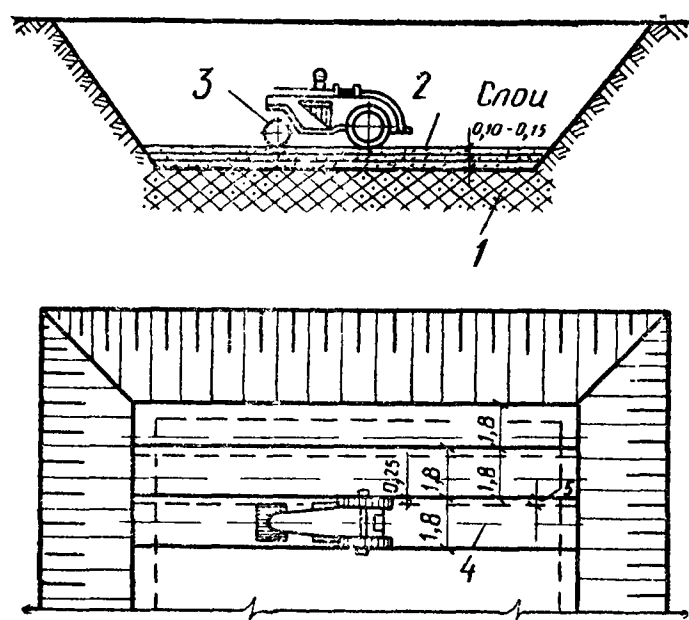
Схема производства работ по уплотнению основания фундаментов под здания и сооружения самоходным катком
